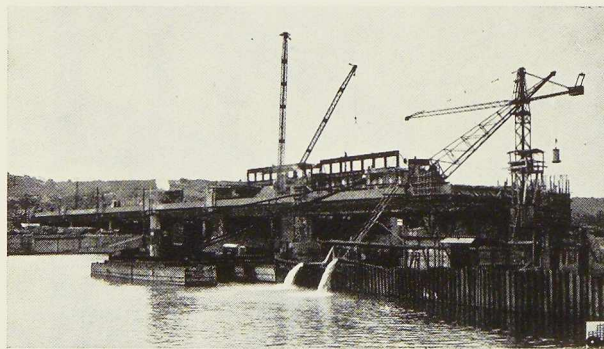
Vue générale du barrage de Ramet-Ivoz en cours de construction. On remarque à droite le batardeau en palplanches métalliques des pertuis en construction.
